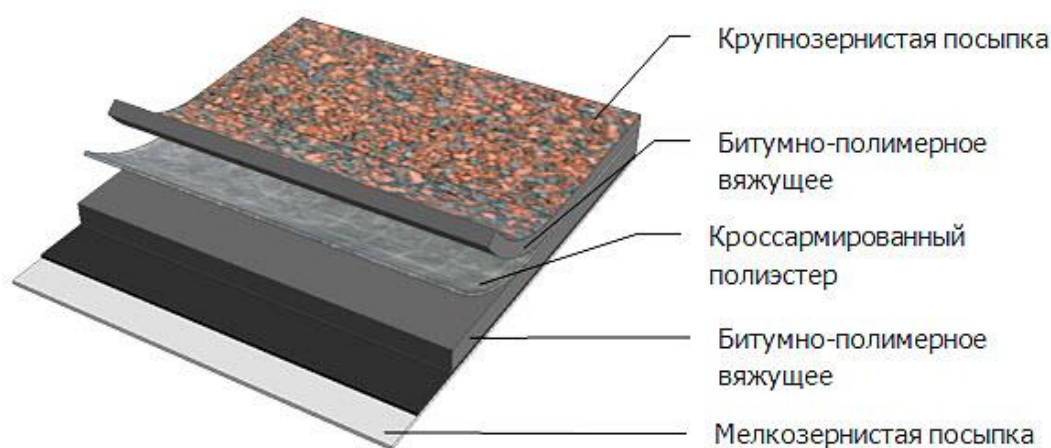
Конструкция кровли на основе битумного рулонного материала
